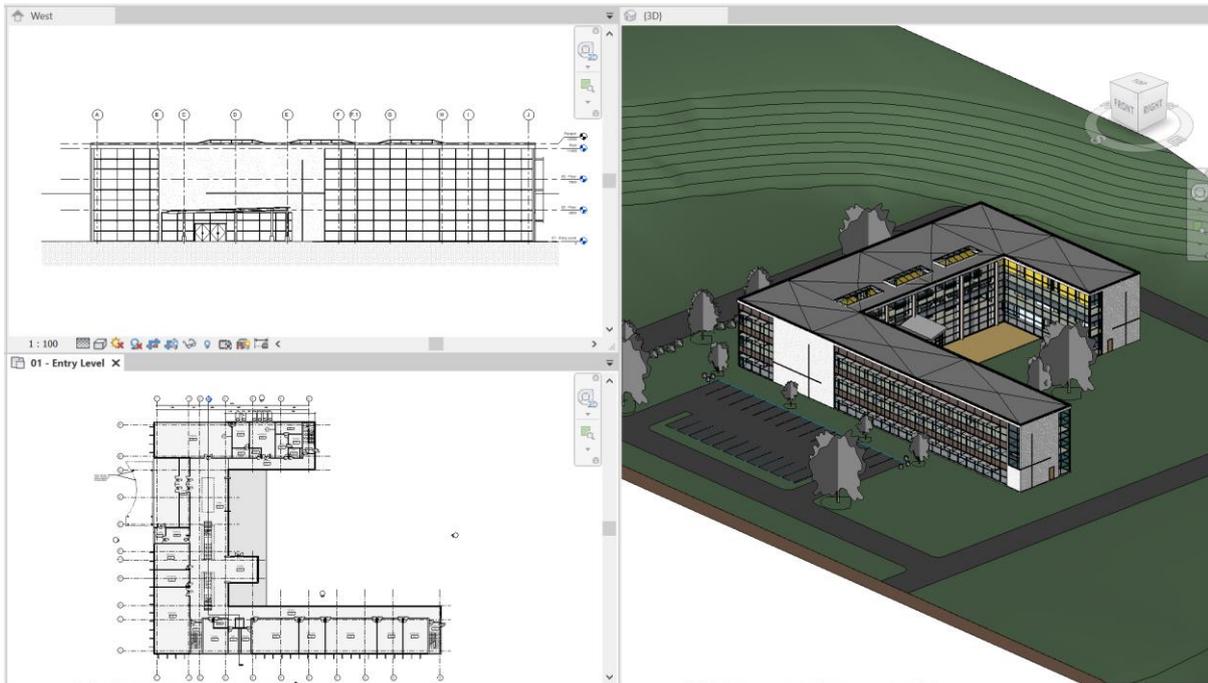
Bauwerk in Darstellung Plan, Ansicht, 3d
